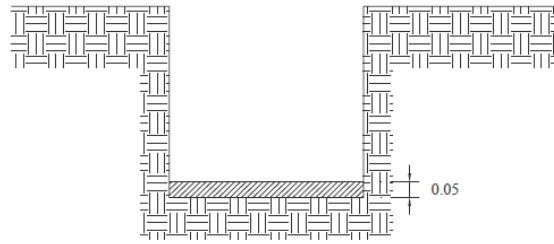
Plantilla de Concreto sin armado $F'c=100\text{kg/cm}^2$
